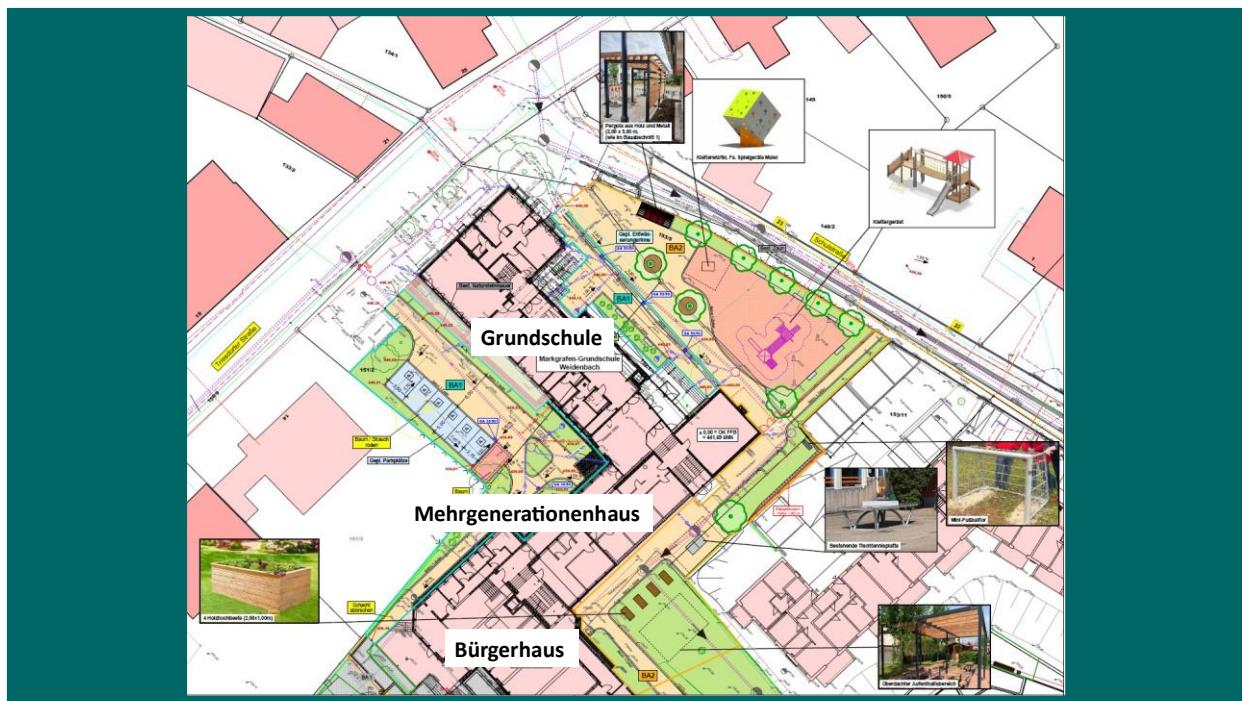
Auszug aus dem Lageplan mit den geplanten Außenanlagen
